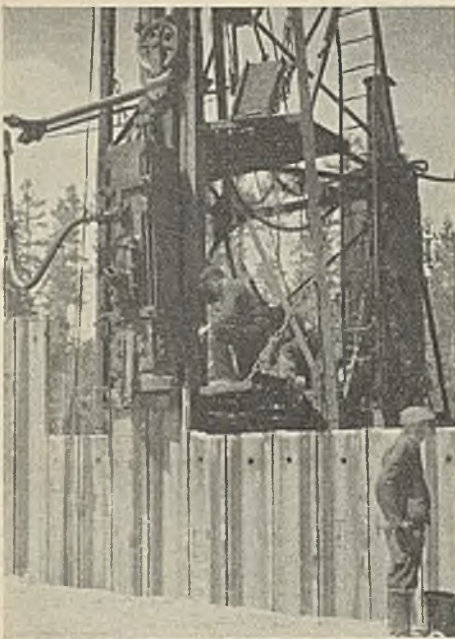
Rammen der Leichtspundwand mit Schnellschlaghammer.
